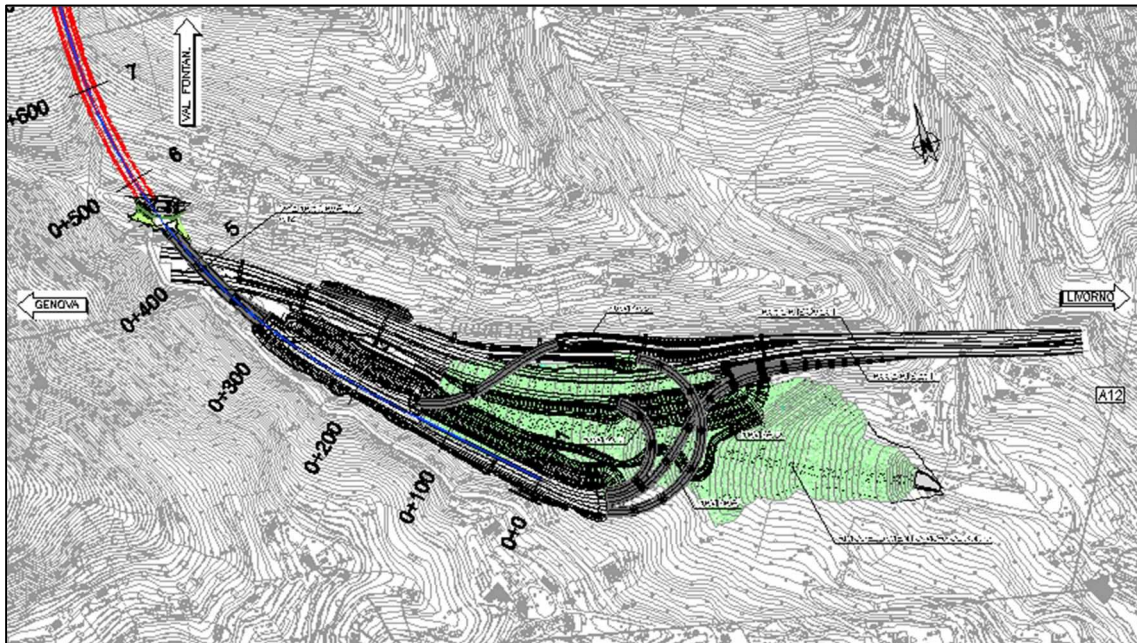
Stralcio planimetrico della zona di intervento lato Rapallo
